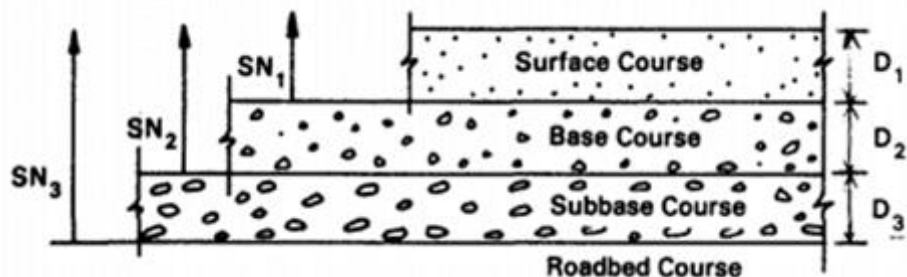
Esquema de estructuración de un pavimento flexible.
